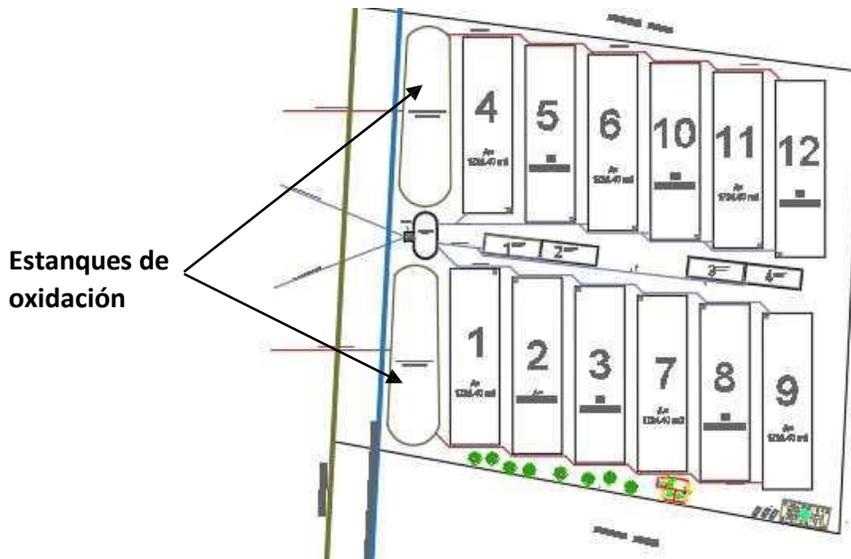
Ubicación de estanques de sedimentación en la planta del conjunto.
